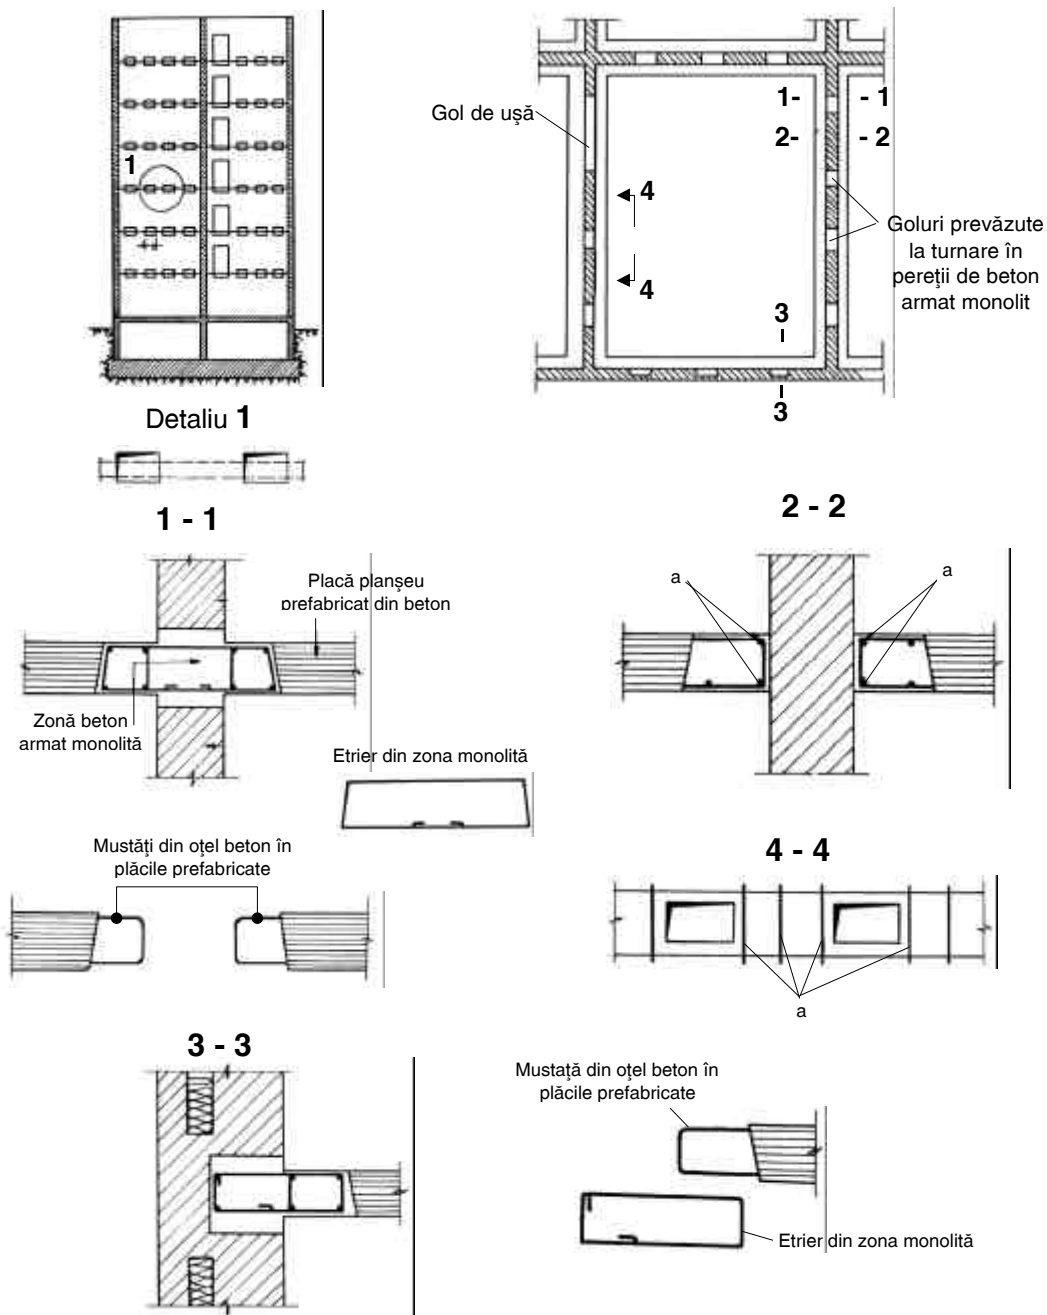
I.4 Planșee prefabricate la structuri din pereți de beton armat monolit
